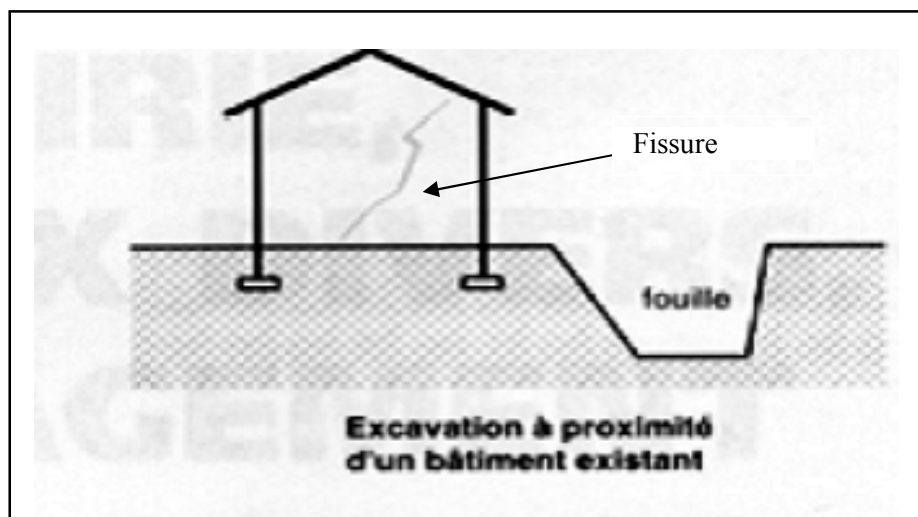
L'instabilité de sol : Cause de d'excavation et déblai. [12]
